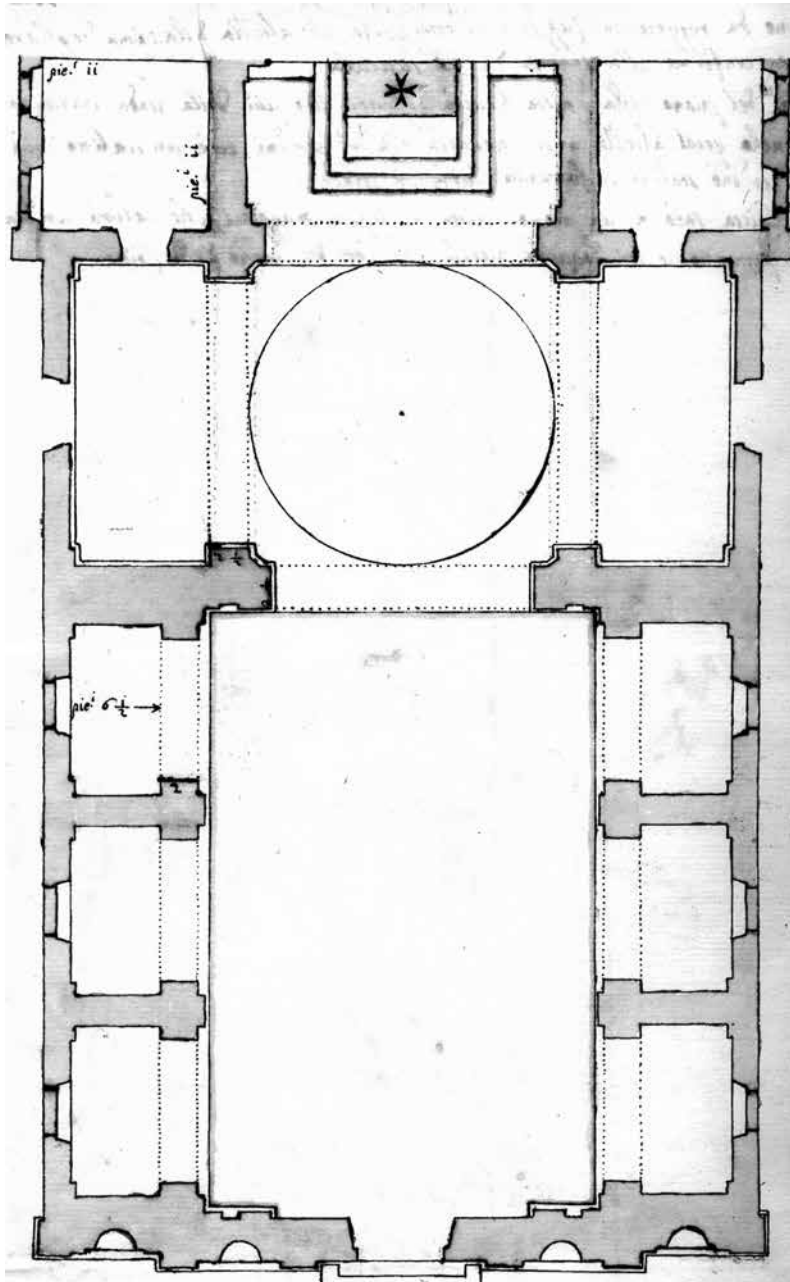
Pianta San Pietro in Valle. Archivio della Congregazione dell'Oratorio, Raffigurazione Chiesa di San Pietro a Fano. Roma, c. II 8a, 144
